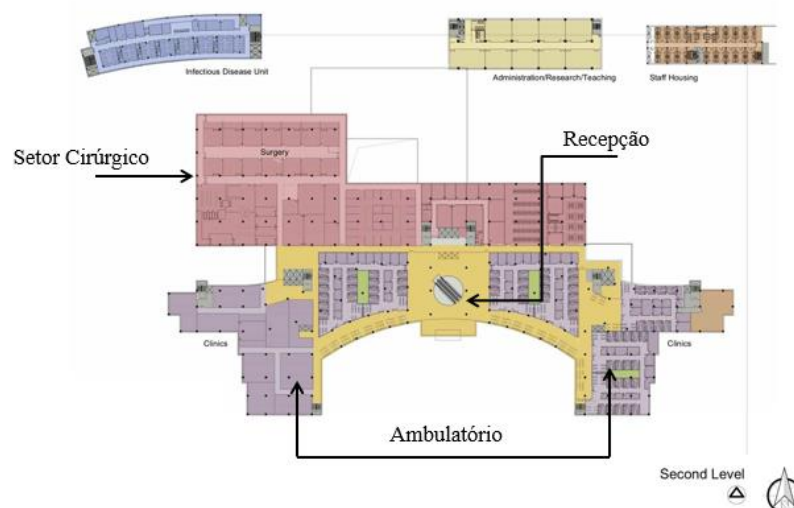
Primeiro Pavimento do Hospital Infantil Suzhou.
